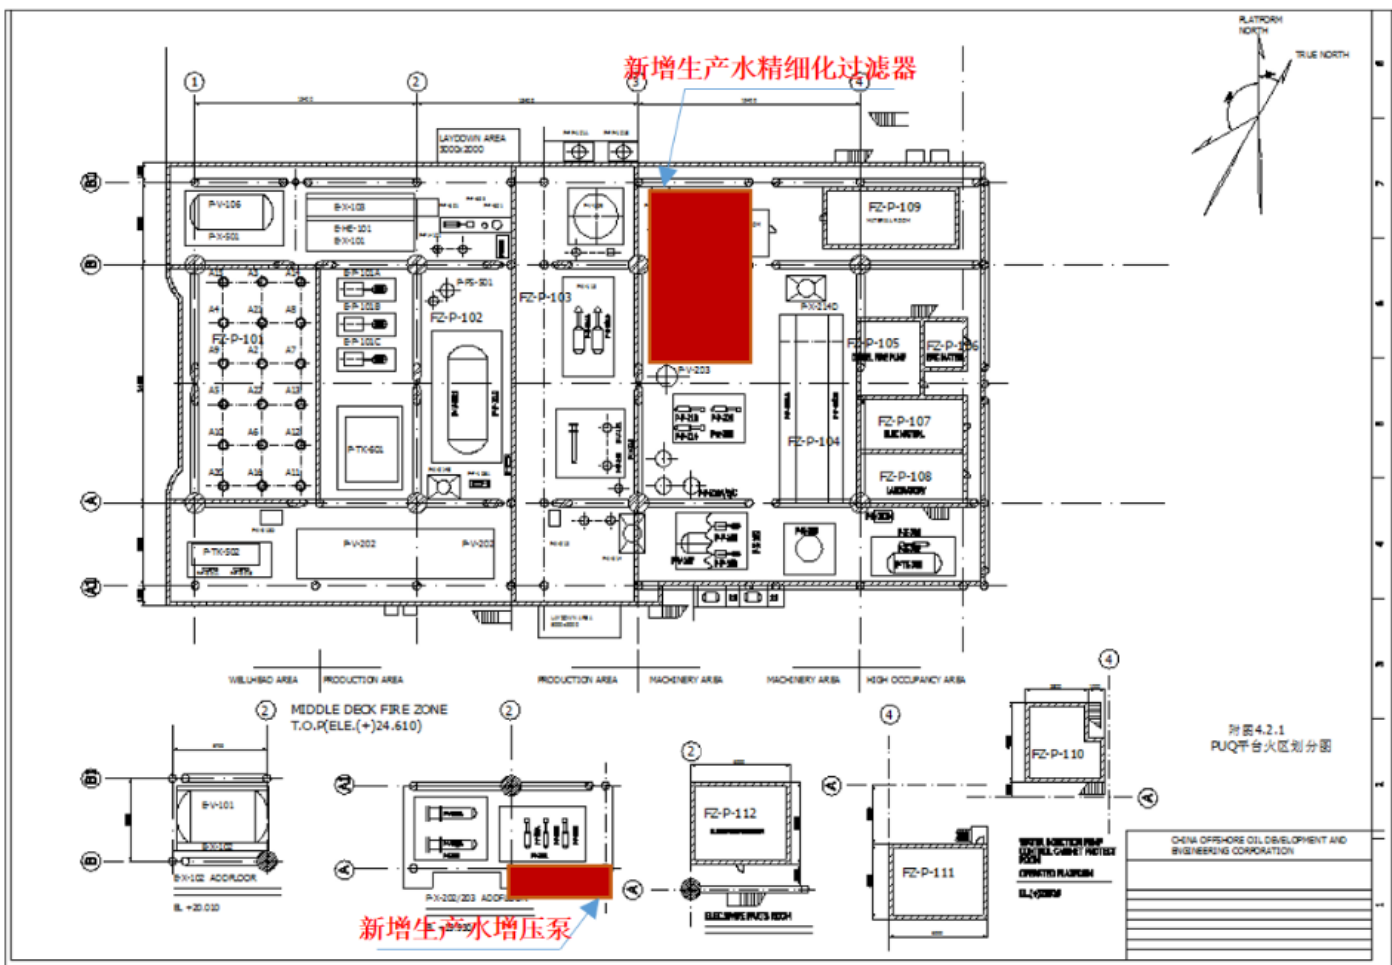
WZ11-4WHPA 平台平面布置示意图
